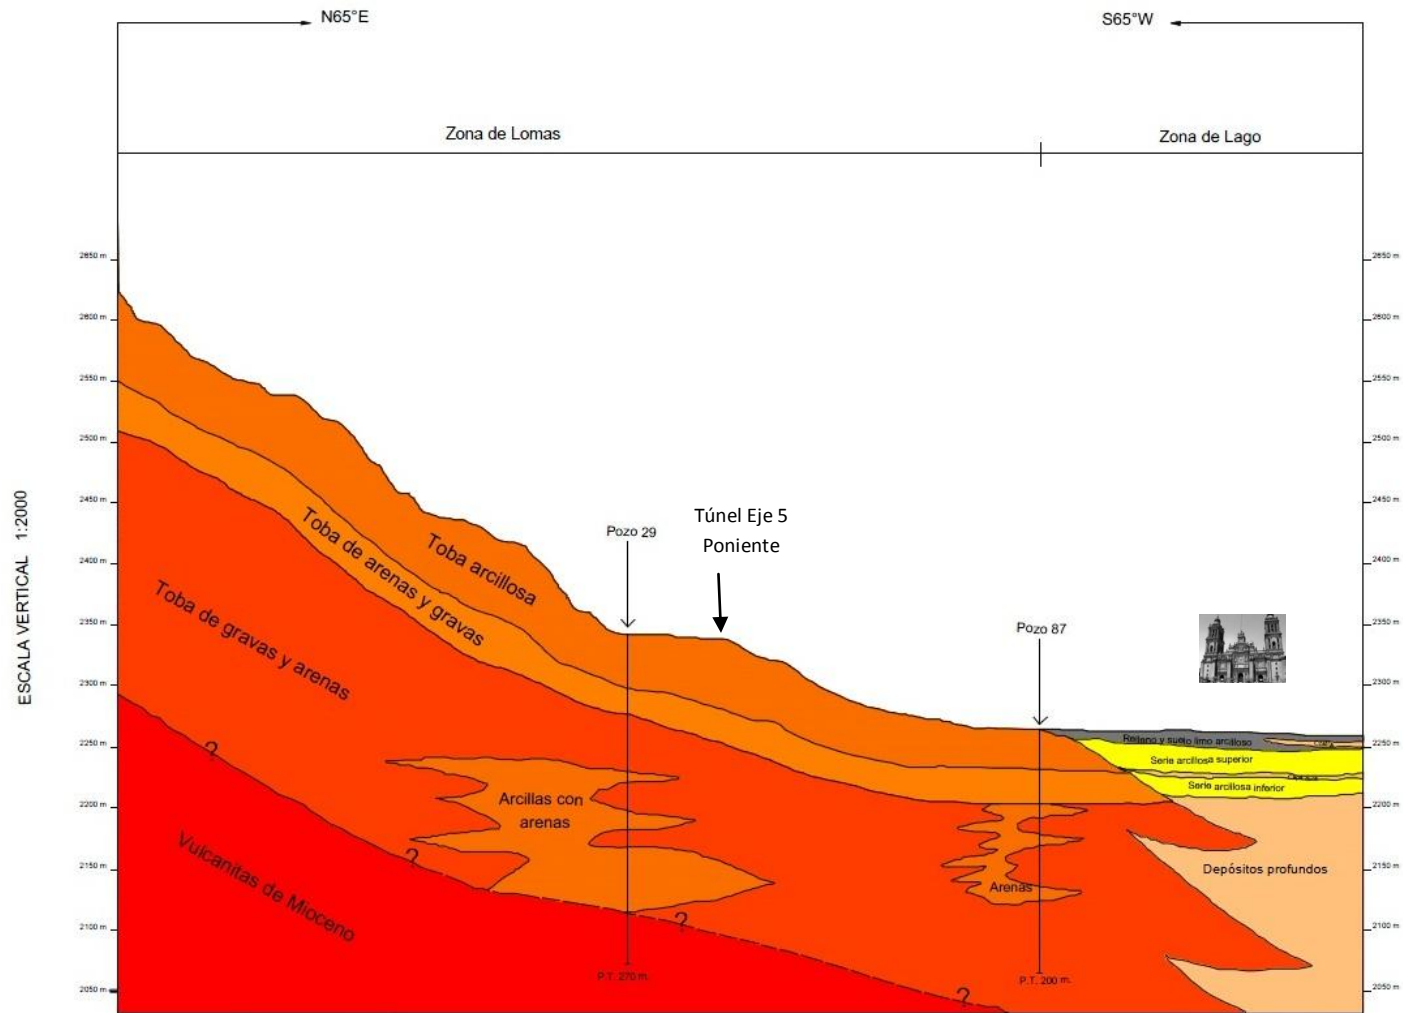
Segunda Sección Geológica “Camino Viejo a Mixcoac-Metro Xola”, escala vertical 1:2,000 y escala horizontal 1:28,500.
